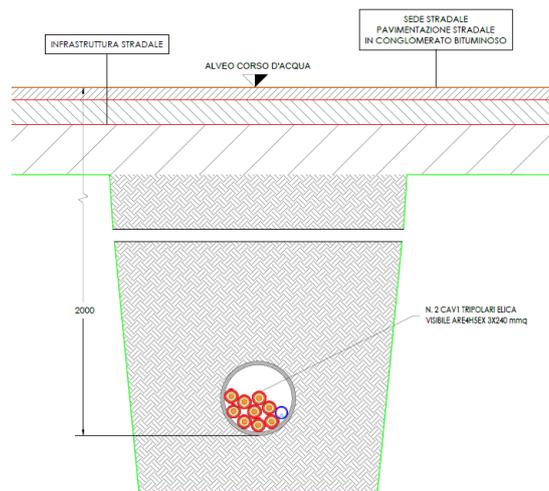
Sezione cavidotti in T.O.C per attraversamenti stradali e corpi idrici
